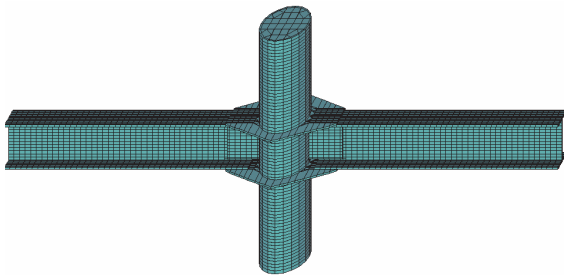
Узел сопряжения трубобетонной колонны с ригелями двутаврового сечения.
